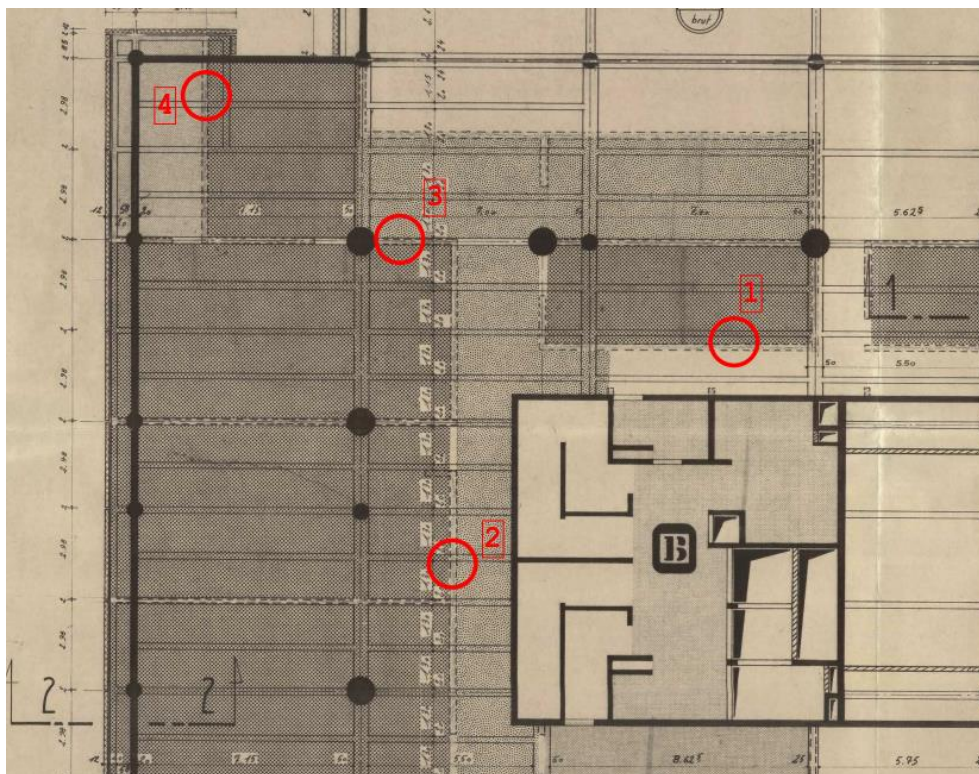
Présence de poutres en tête des murs parpaings sur plan PHT RDC
